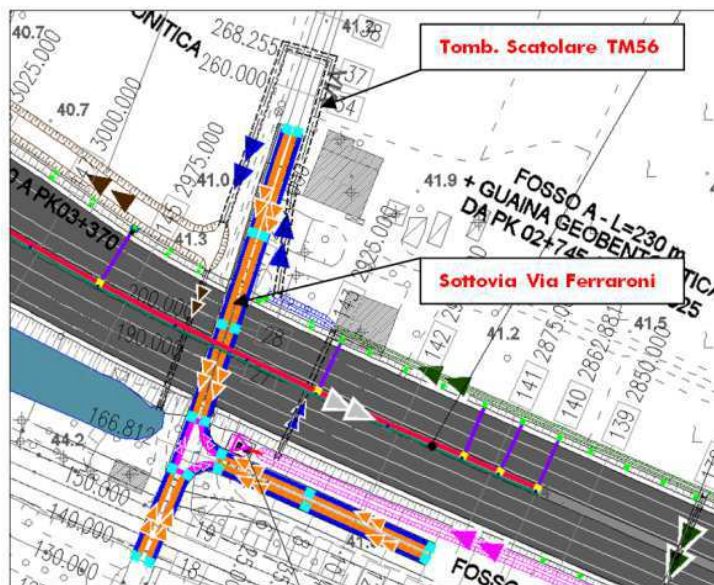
stralcio planimetrico del supermanto del sottovia di Via Ferraroni
